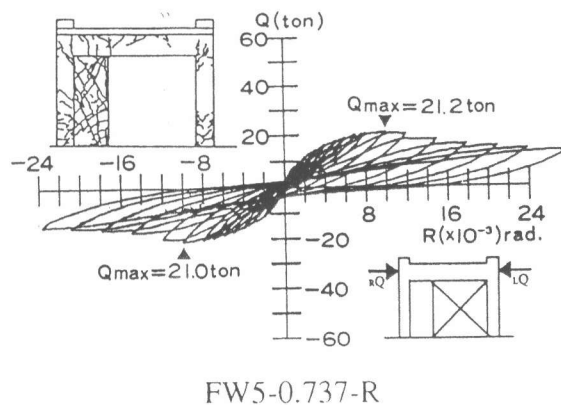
水平荷重-変形曲線および水平耐力時のひび割れ状況
